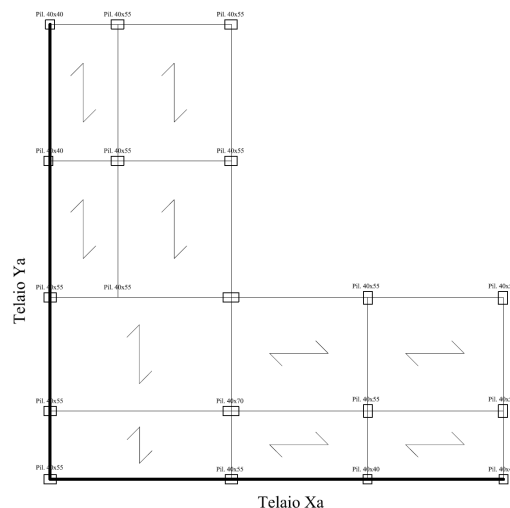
Pianta struttura campione ReLUIS IRREG.02 – In neretto i telai perimetrali cui sono stati applicati cedimenti
